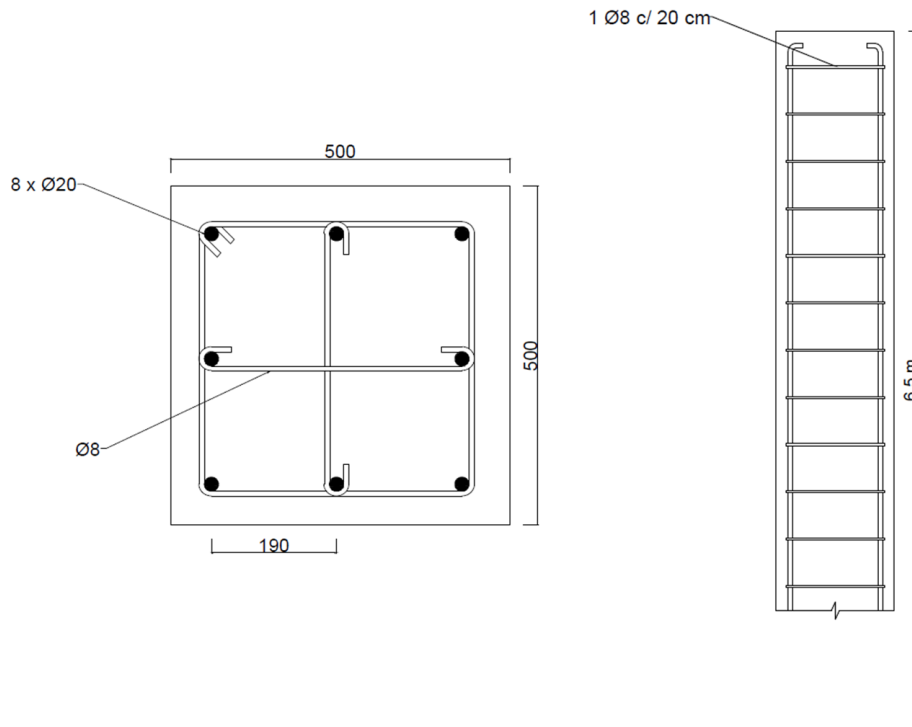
Pilares Intermedios (fuente: elaboración propia)
